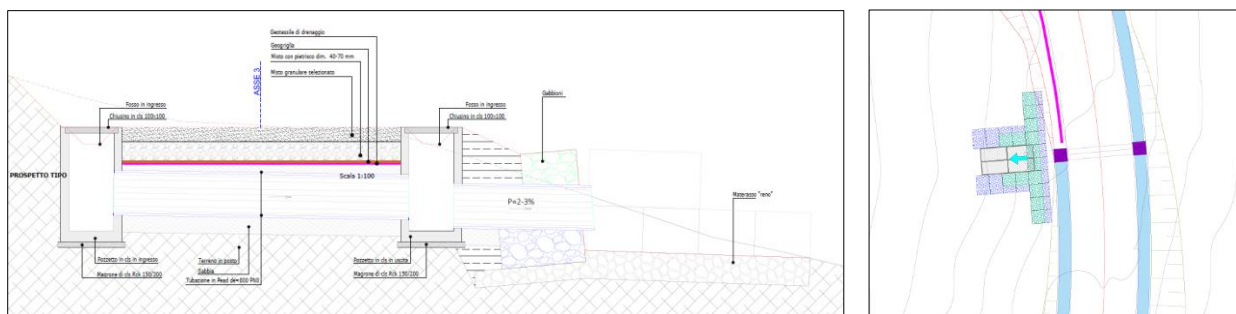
Sezione e planimetria tipologica allontanamento acque meteoriche
